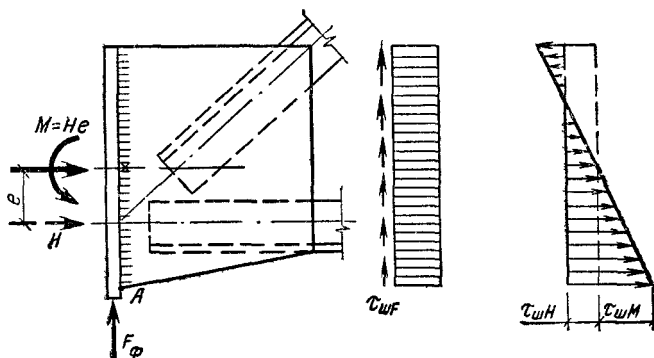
Узел опирания стропильной фермы на колонну сбоку
